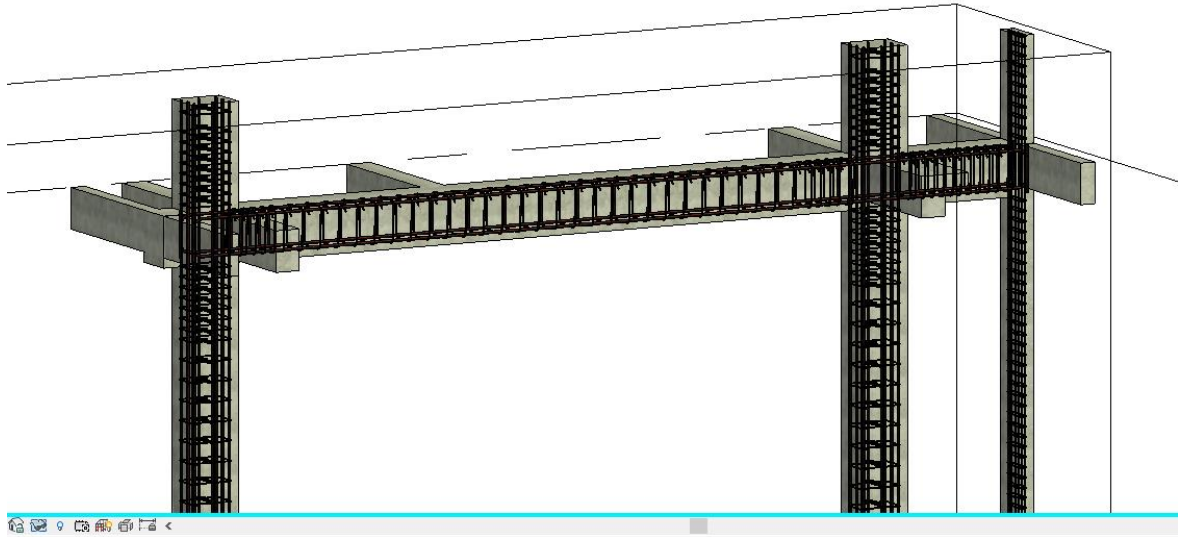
Vista 3D distribución de acero en Vigas (Fuente: Elaboración Propia).
